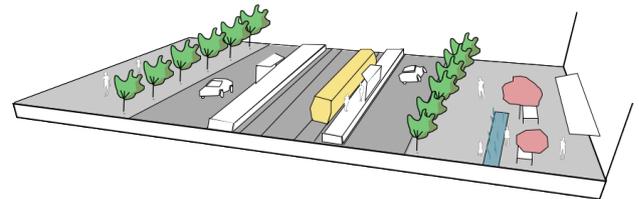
Wasenstraße Umgestaltung (Eigene Darstellung)
